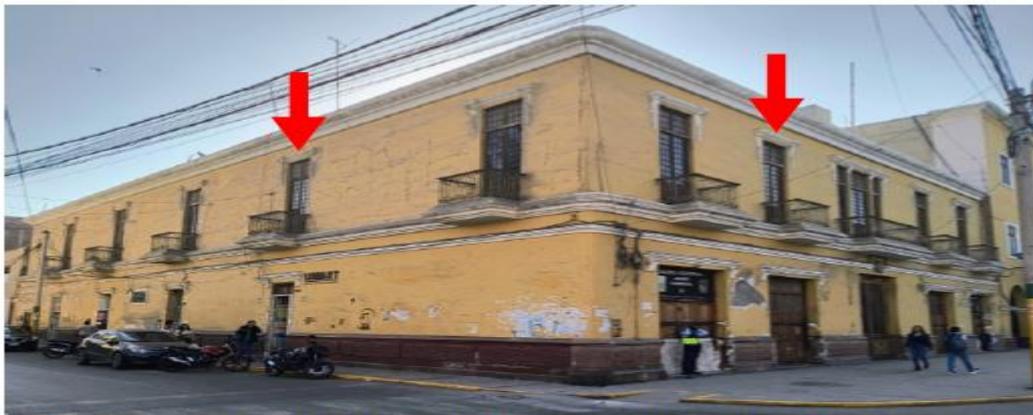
Inmueble ubicado en esquina de calle Libertad con calle Bolívar.
